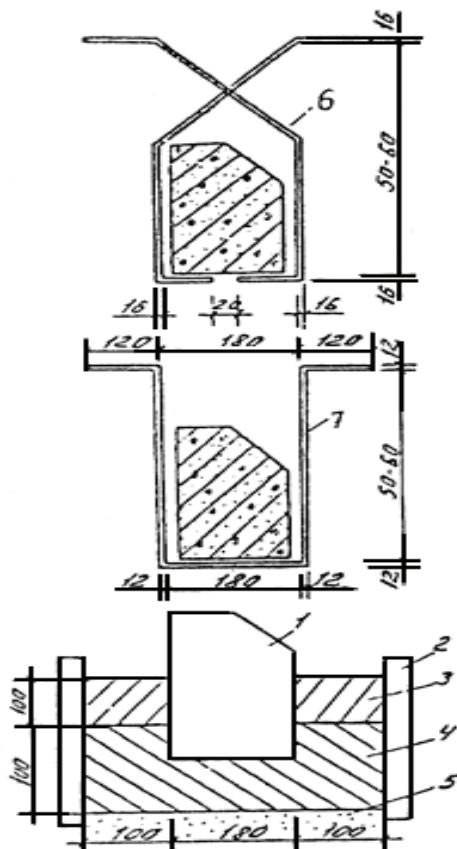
Схема установки бортовых камней при помощи приспособлений
